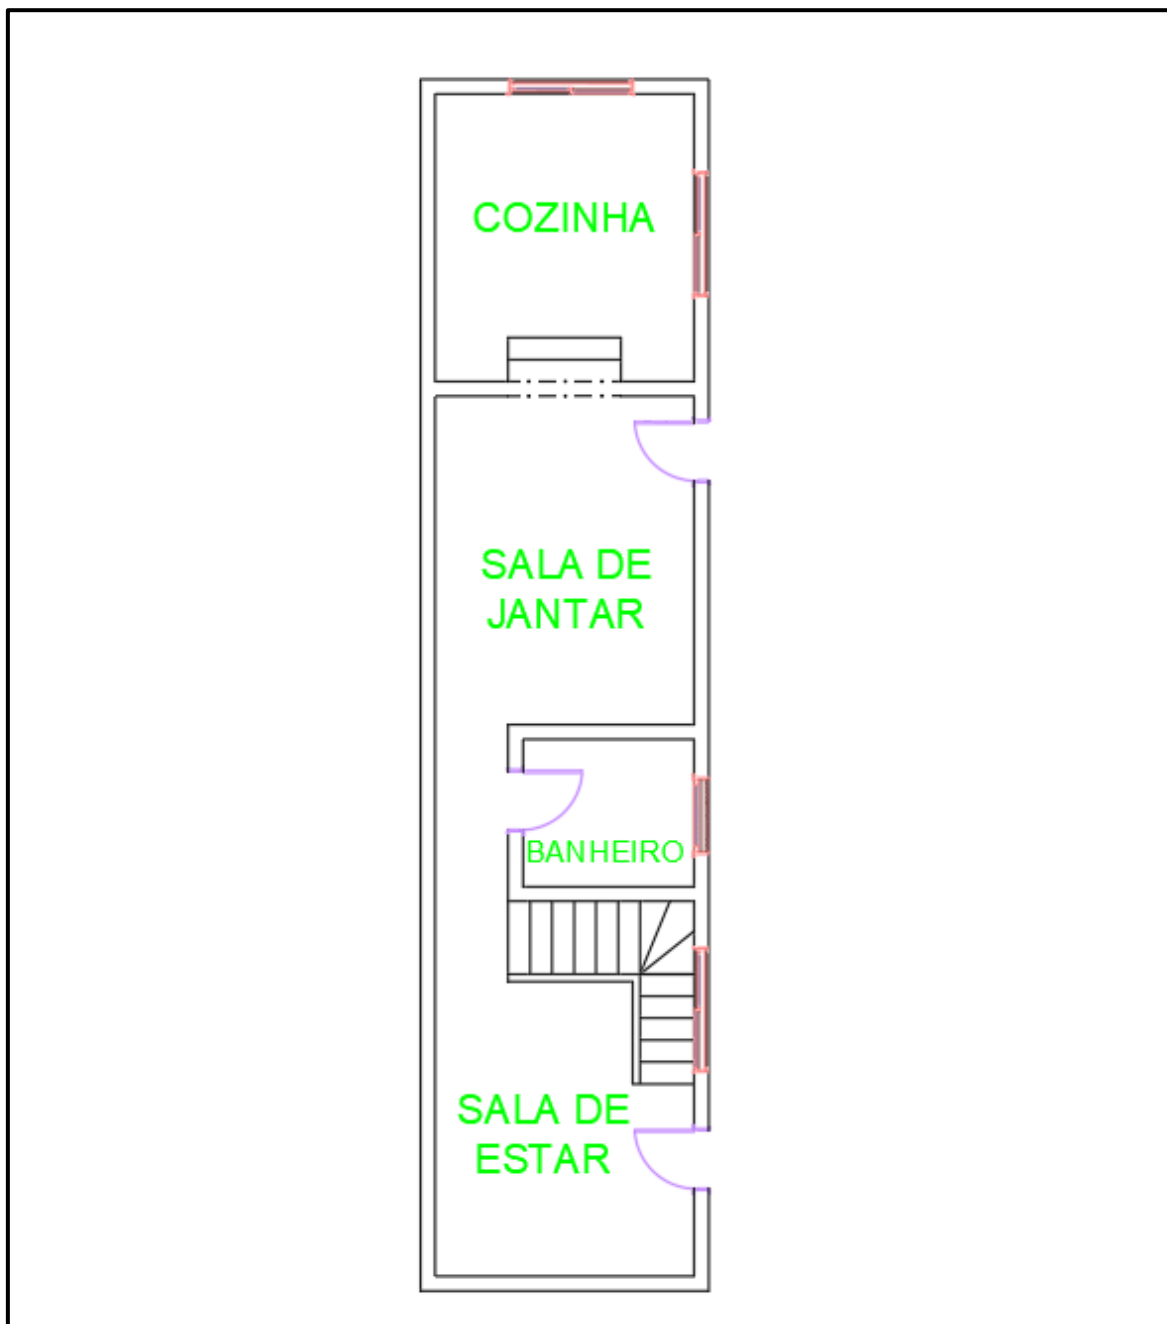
Cozinha erigida no 1º pavimento do terreno avaliando
